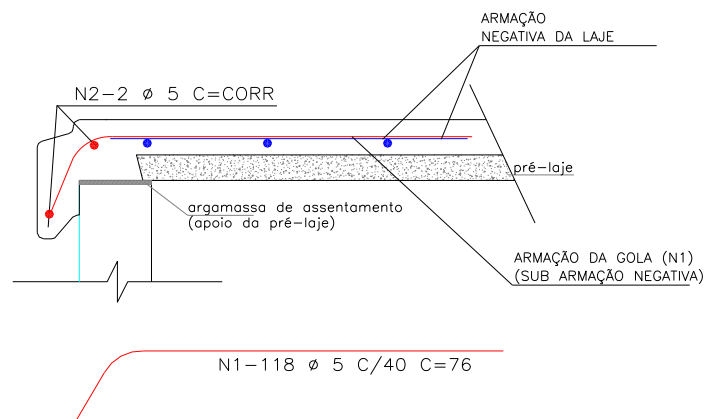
Desenho esquemático das pré-lajes apoiadas no painel e da armadura das golas
